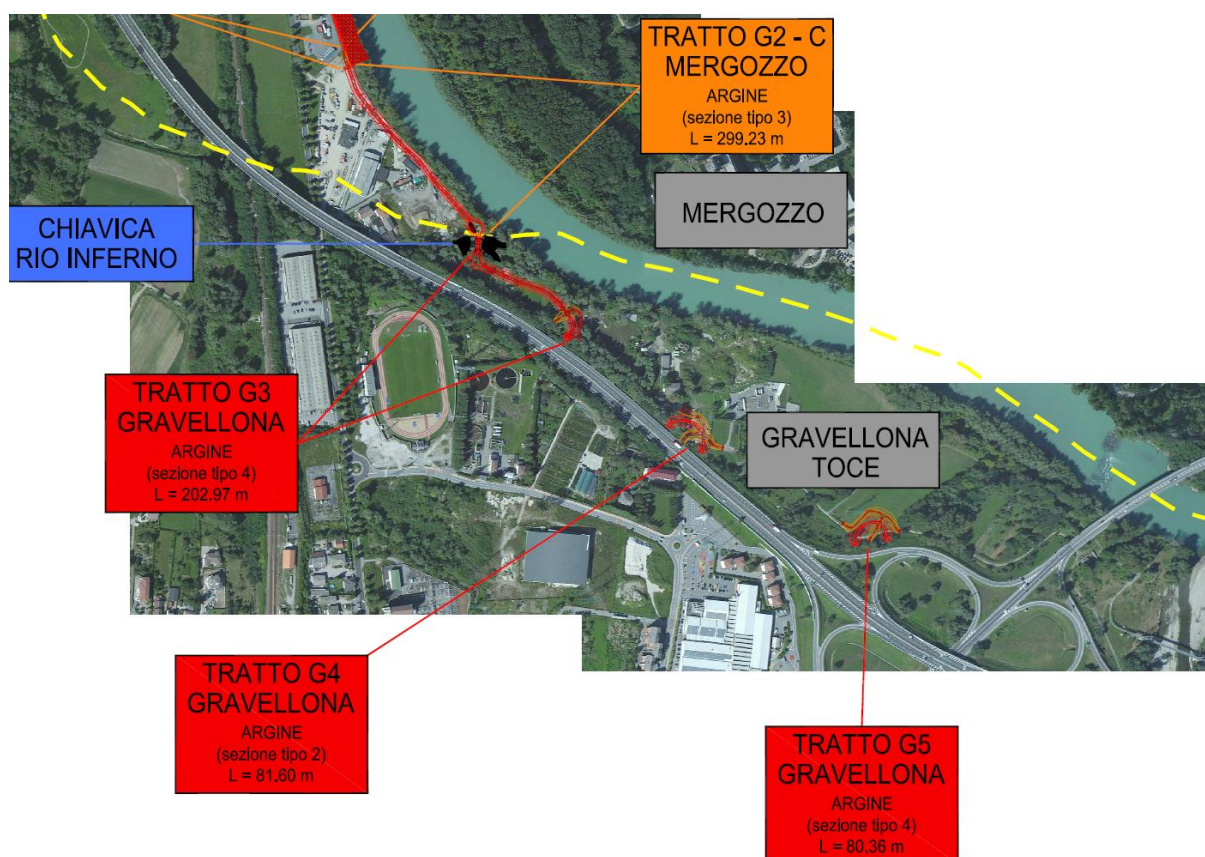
Dettaglio della planimetria delle opere in progetto nei pressi del depuratore di Gravello Toce
